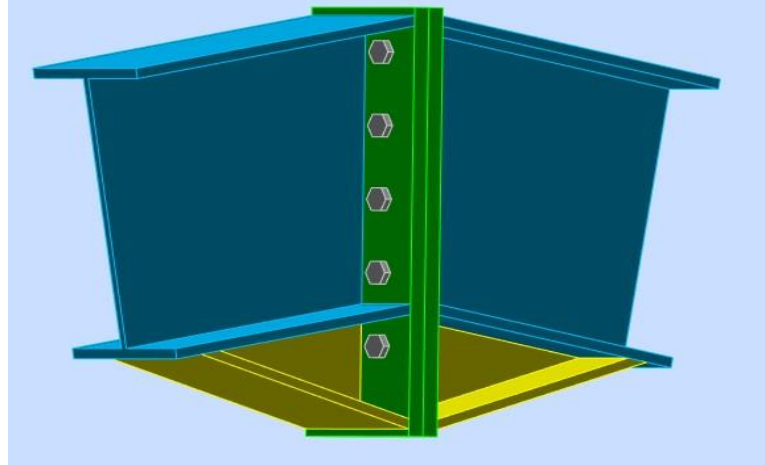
Vue 3D de l'assemblage traverse-traverse
